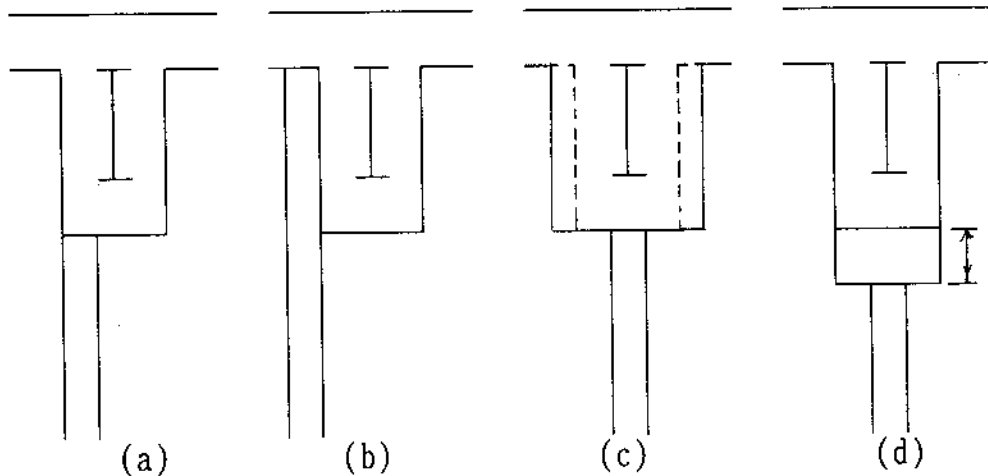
梁下與牆相連混凝土澆置施工困難可做之變更
